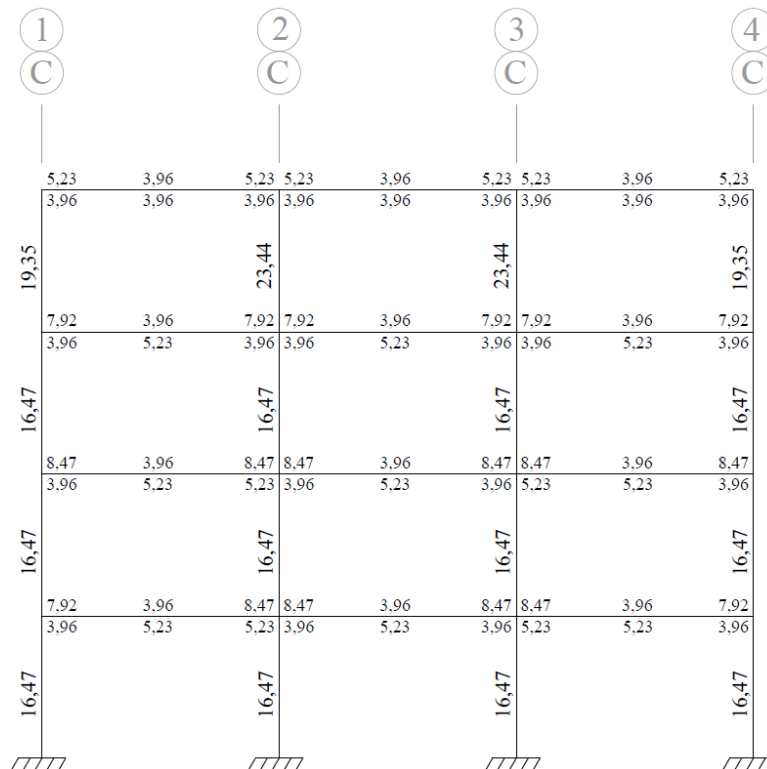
Área de acero colocada en cm^2 en el pórtico 2.
